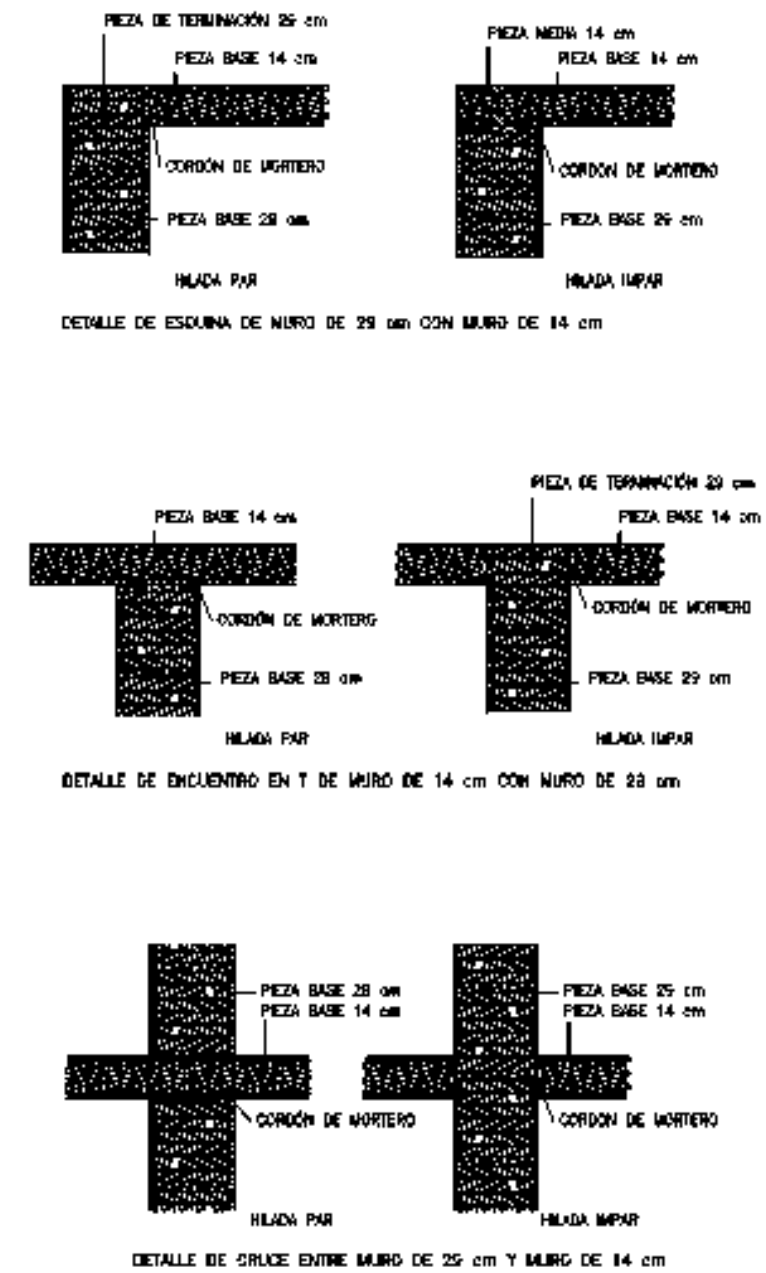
Detalles de encuentro de piezas de 29 cm con piezas de 14 cm.
